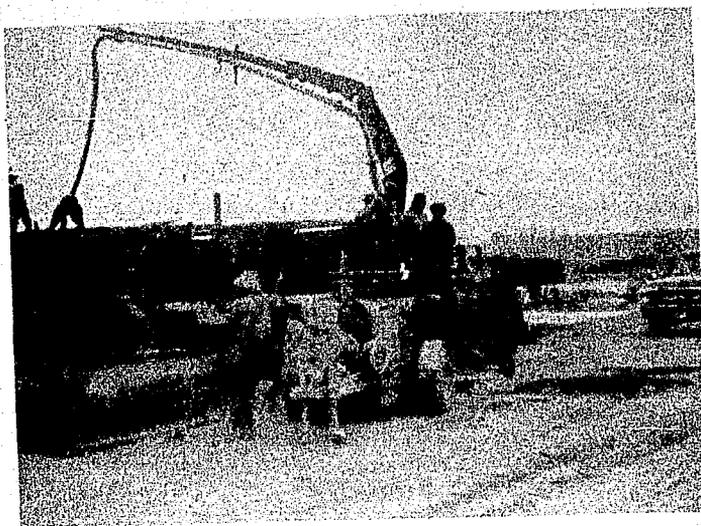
Vaciado y picado del concreto; en este caso el colado se realiza con bomba.
